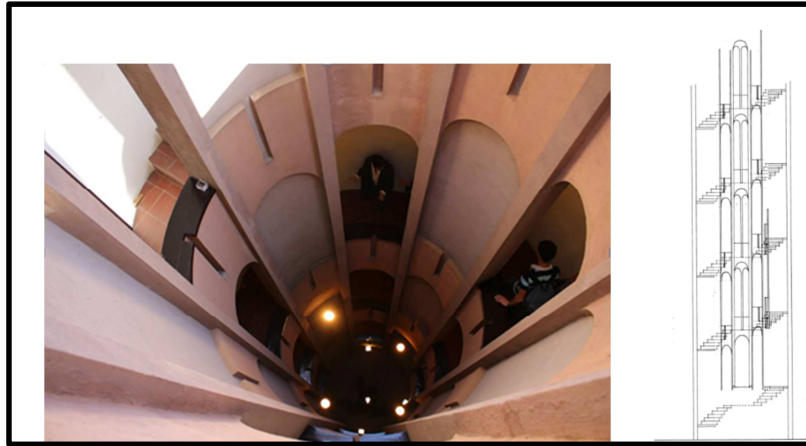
vue de l'intérieur de l'escalier et une coupe , source: Taller de arquitectura ou la fabrica – Ricardo Bofill
